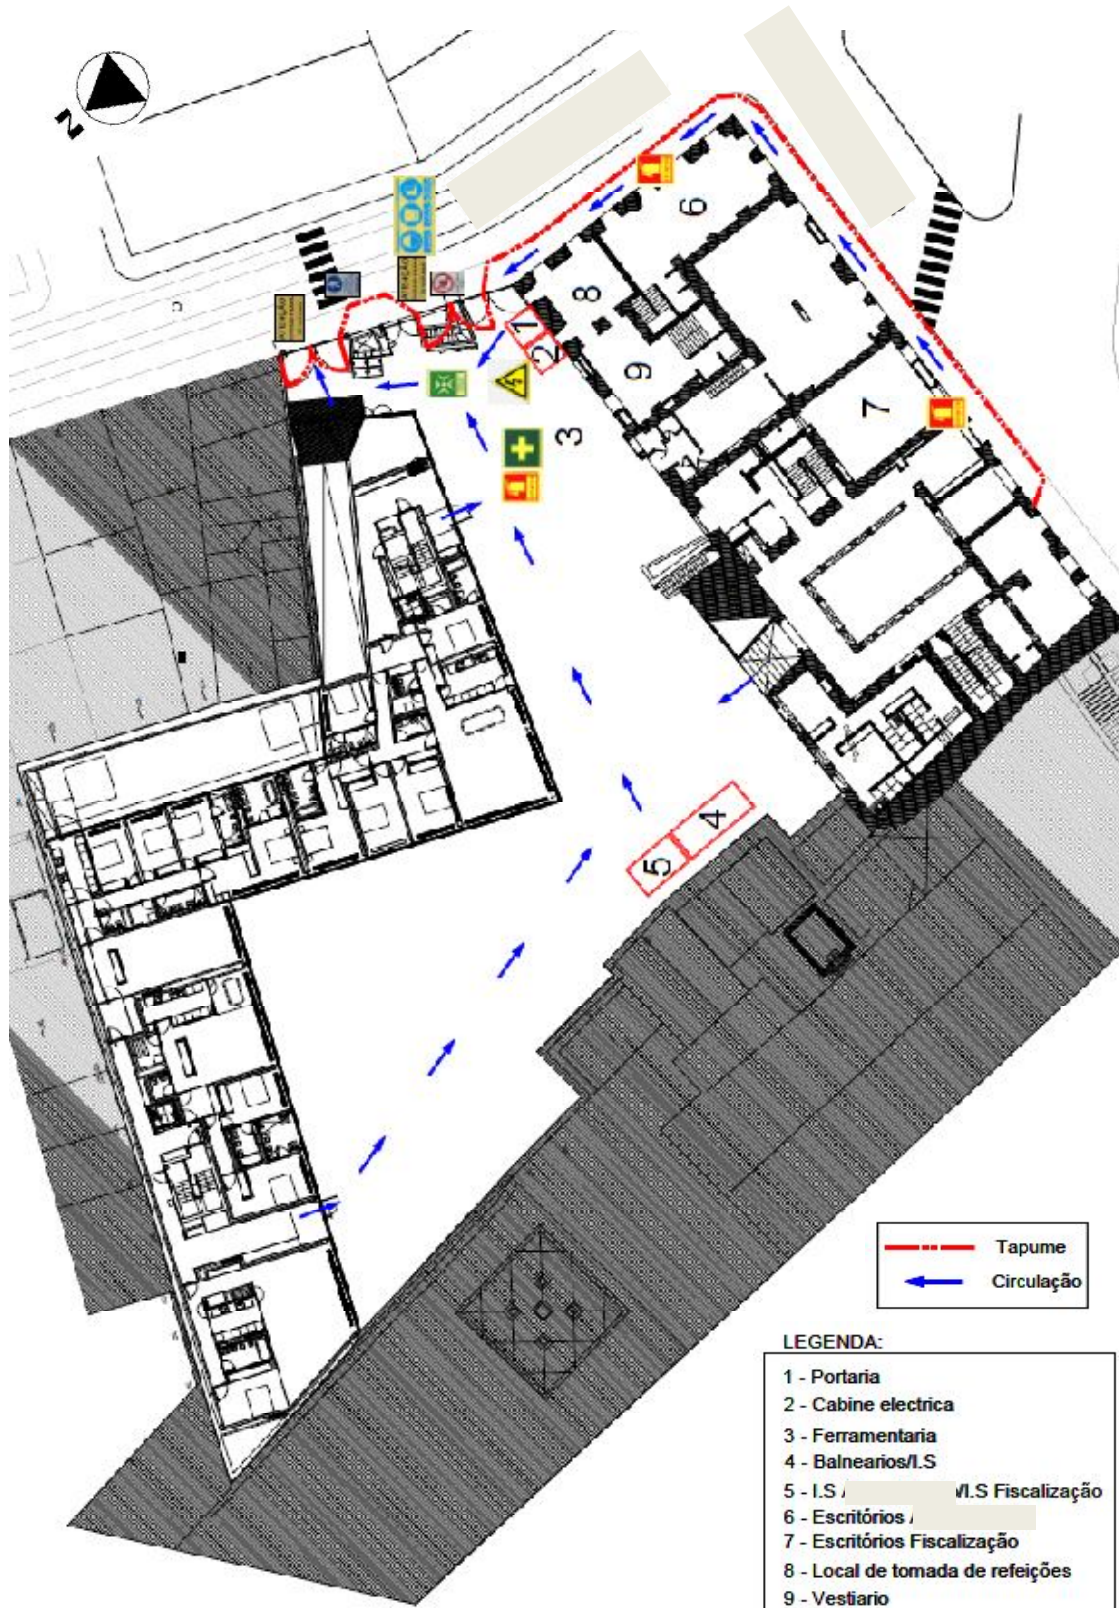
Planta de estaleiro da Obra A (sem Escala).
